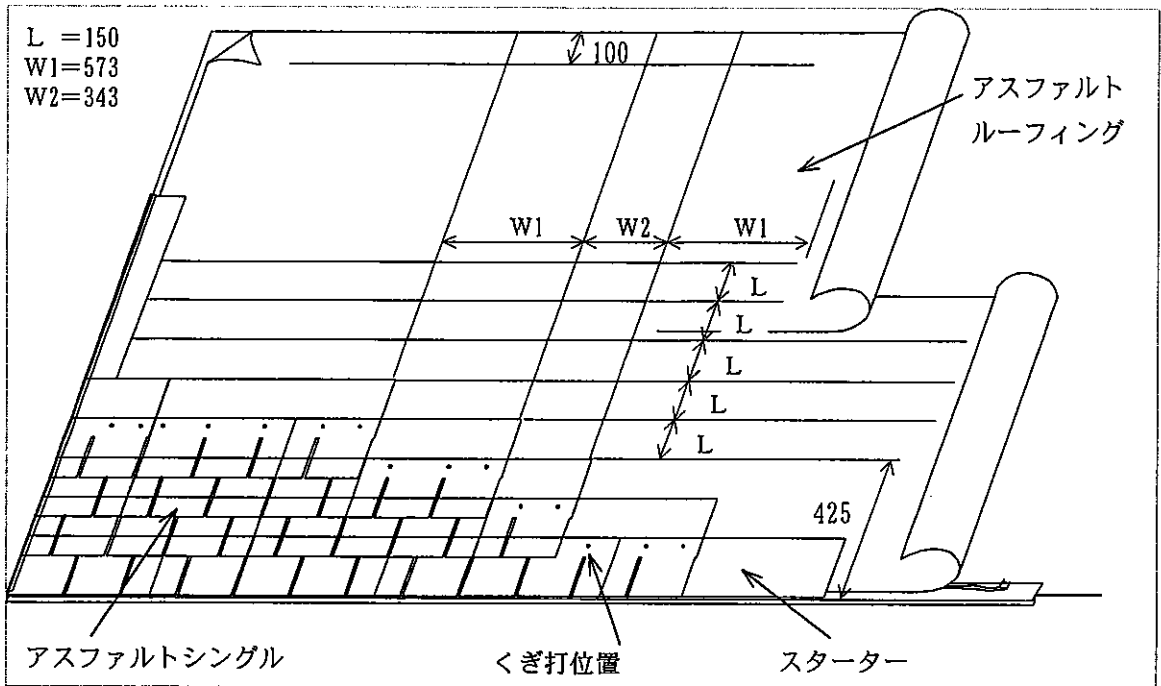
申請仕様の施工図 (アスファルトシングルの施工: 1タブ~4タブ)
